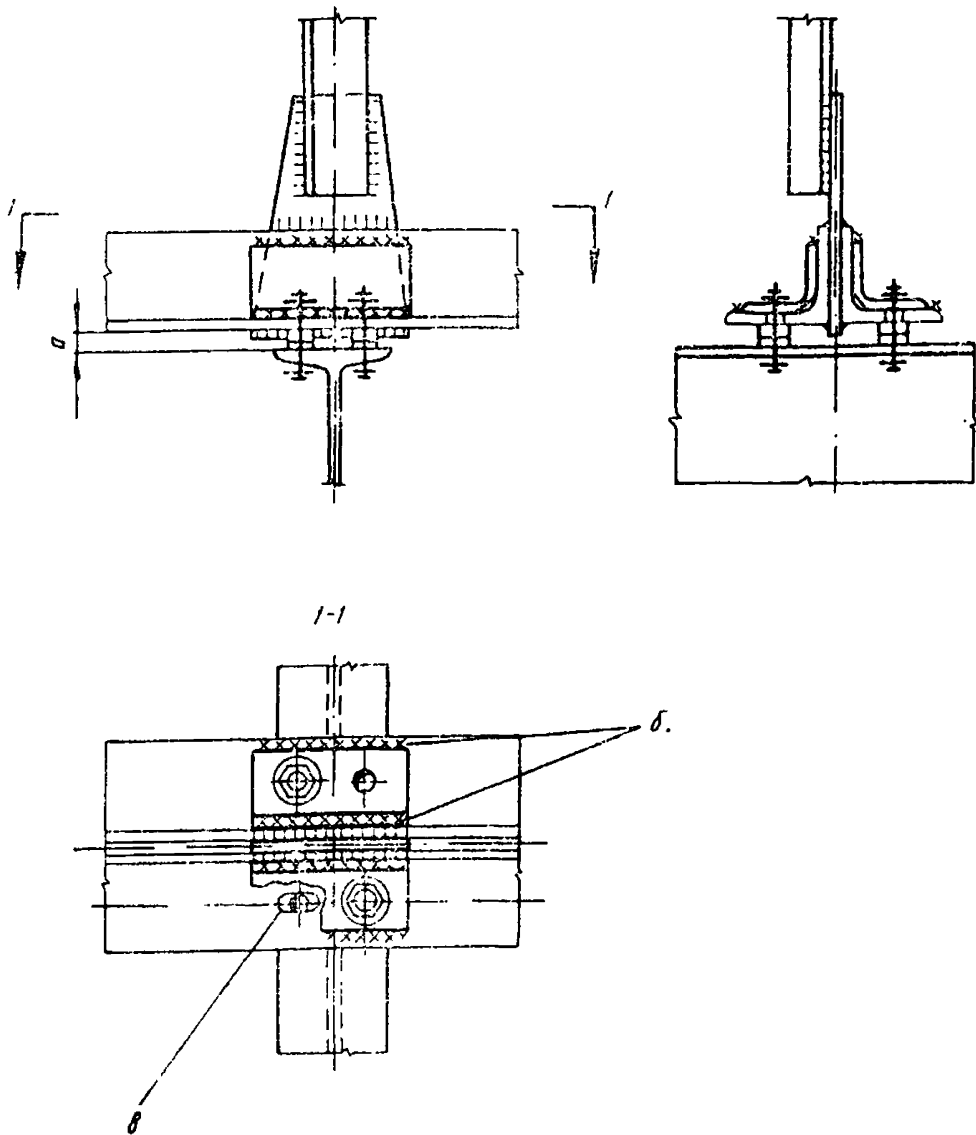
Деталь крепления подвесной балки к металлической ферме
